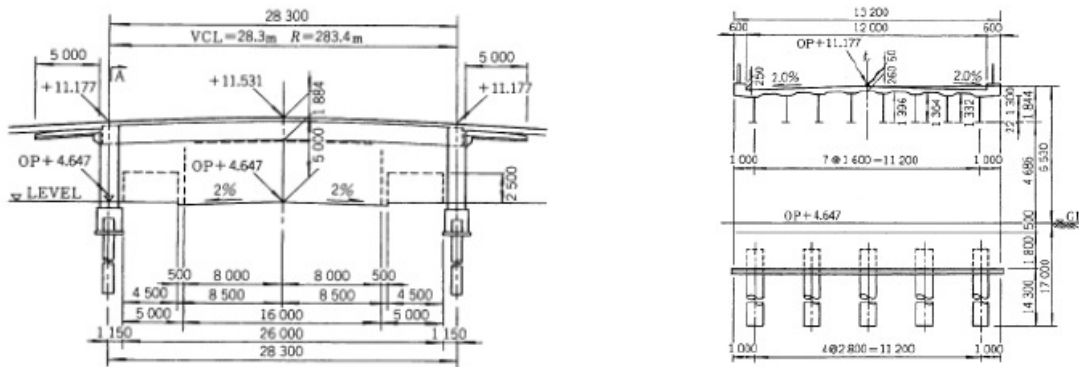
Nishihama Bridge - Sezioni longitudinale e trasversale (Nakamura et al., 2002)
